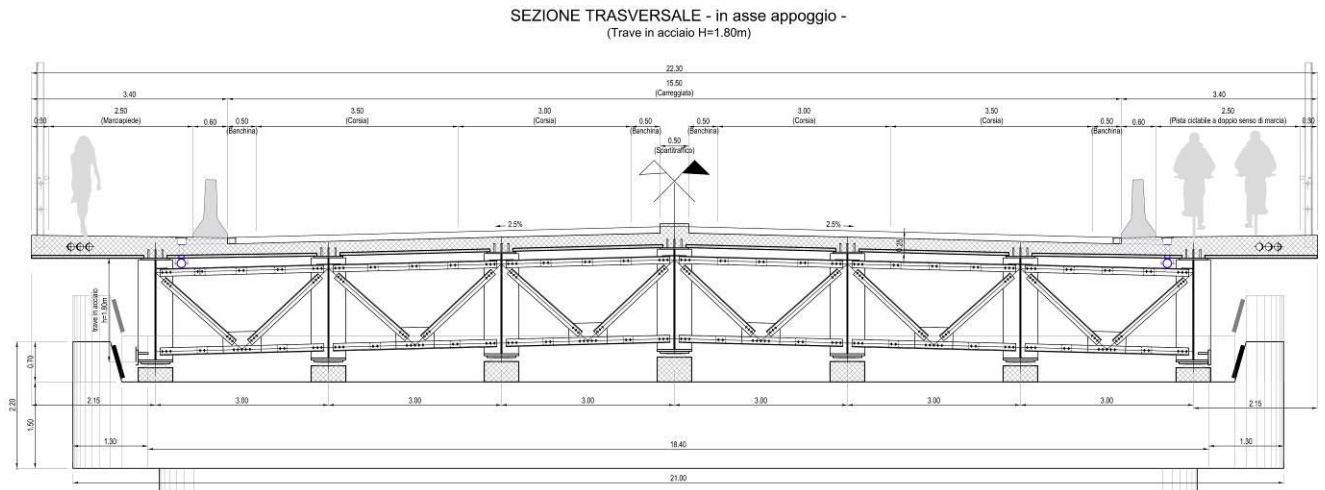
Sezione trasversale dell’opera con trave in acciaio
